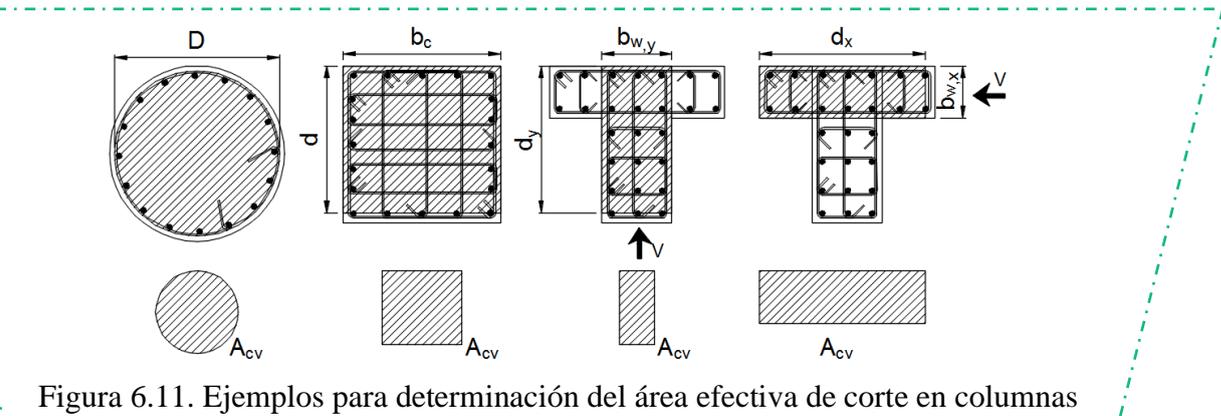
Ejemplos para determinación del área efectiva de corte en columnas
